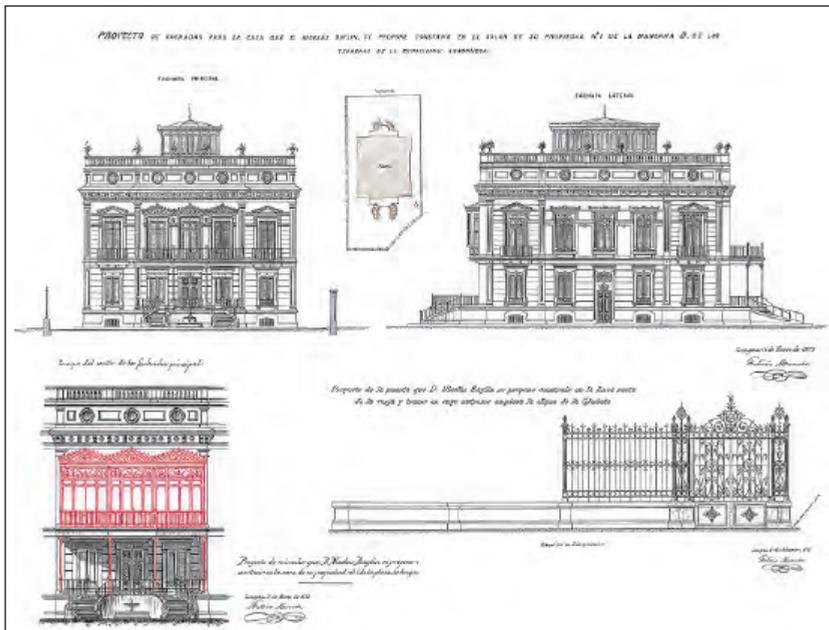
Plaza de Aragón n° 1 (Antonio Miranda, —montaje— fachadas y emplazamiento, 11-1-1879; puerta en la verja de cerramiento, 17-9-1879; y mirador en la fachada principal, 31-3-1885) [A.M.Z.]
